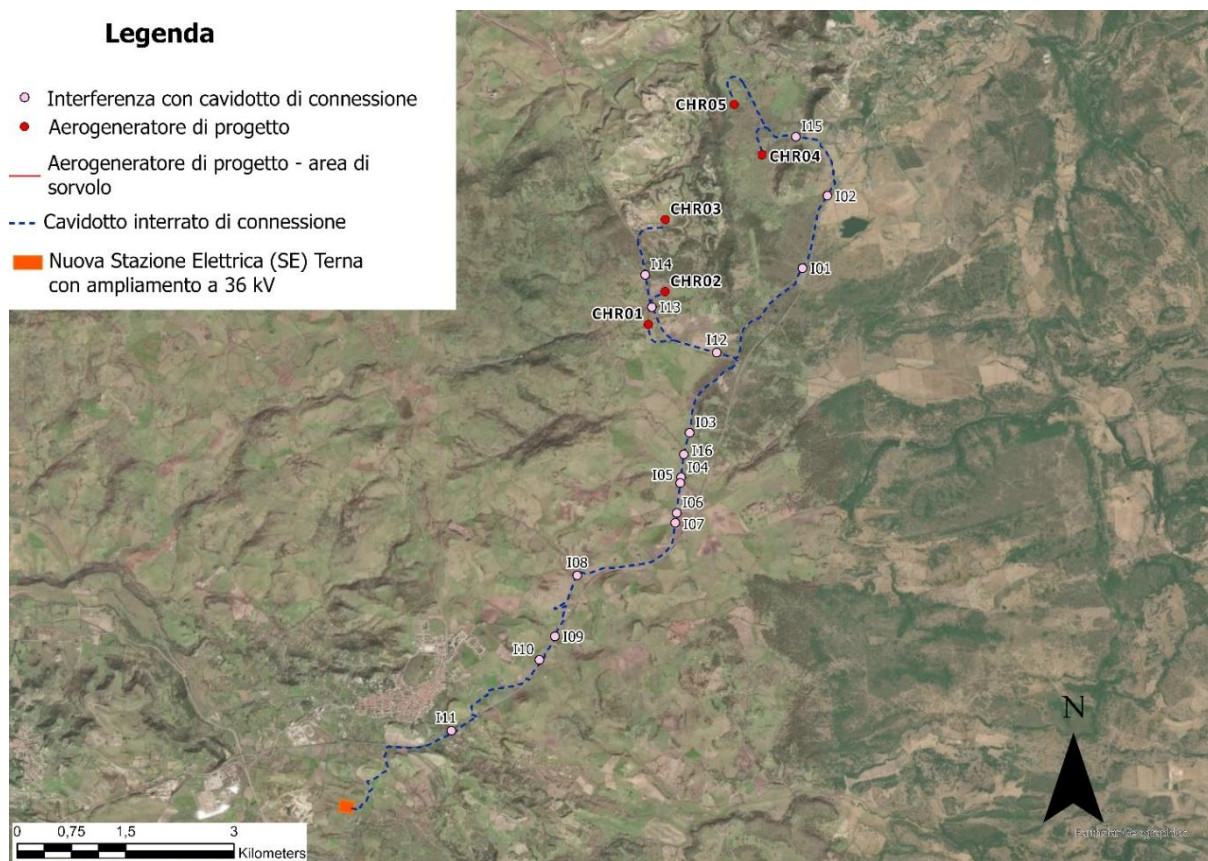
Planimetria cavidotto di connessione 36 kV.
